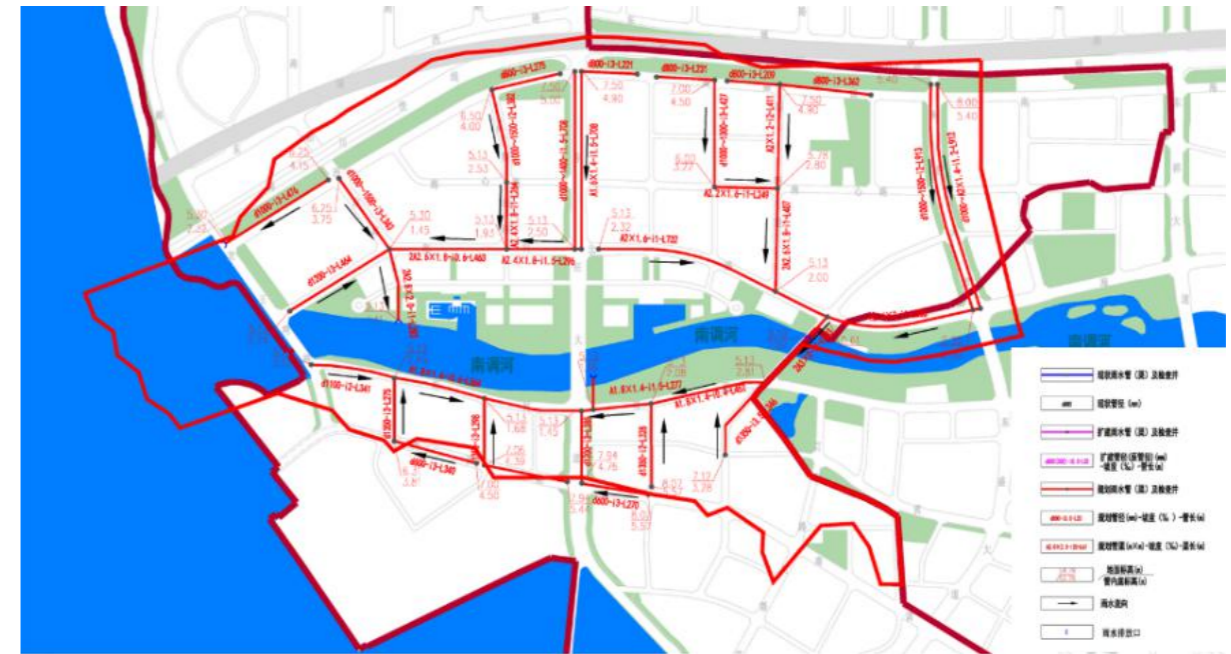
南调河下游分区远期新、改扩建雨水管渠平面图
